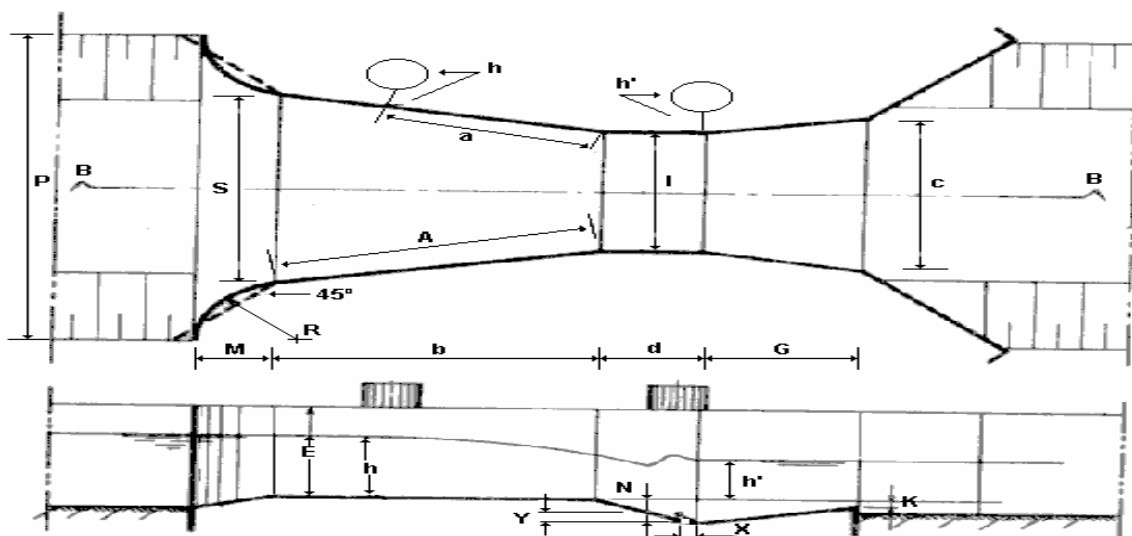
Representação em planta do medidor do tipo Parshall (Lencastre, 1996)
